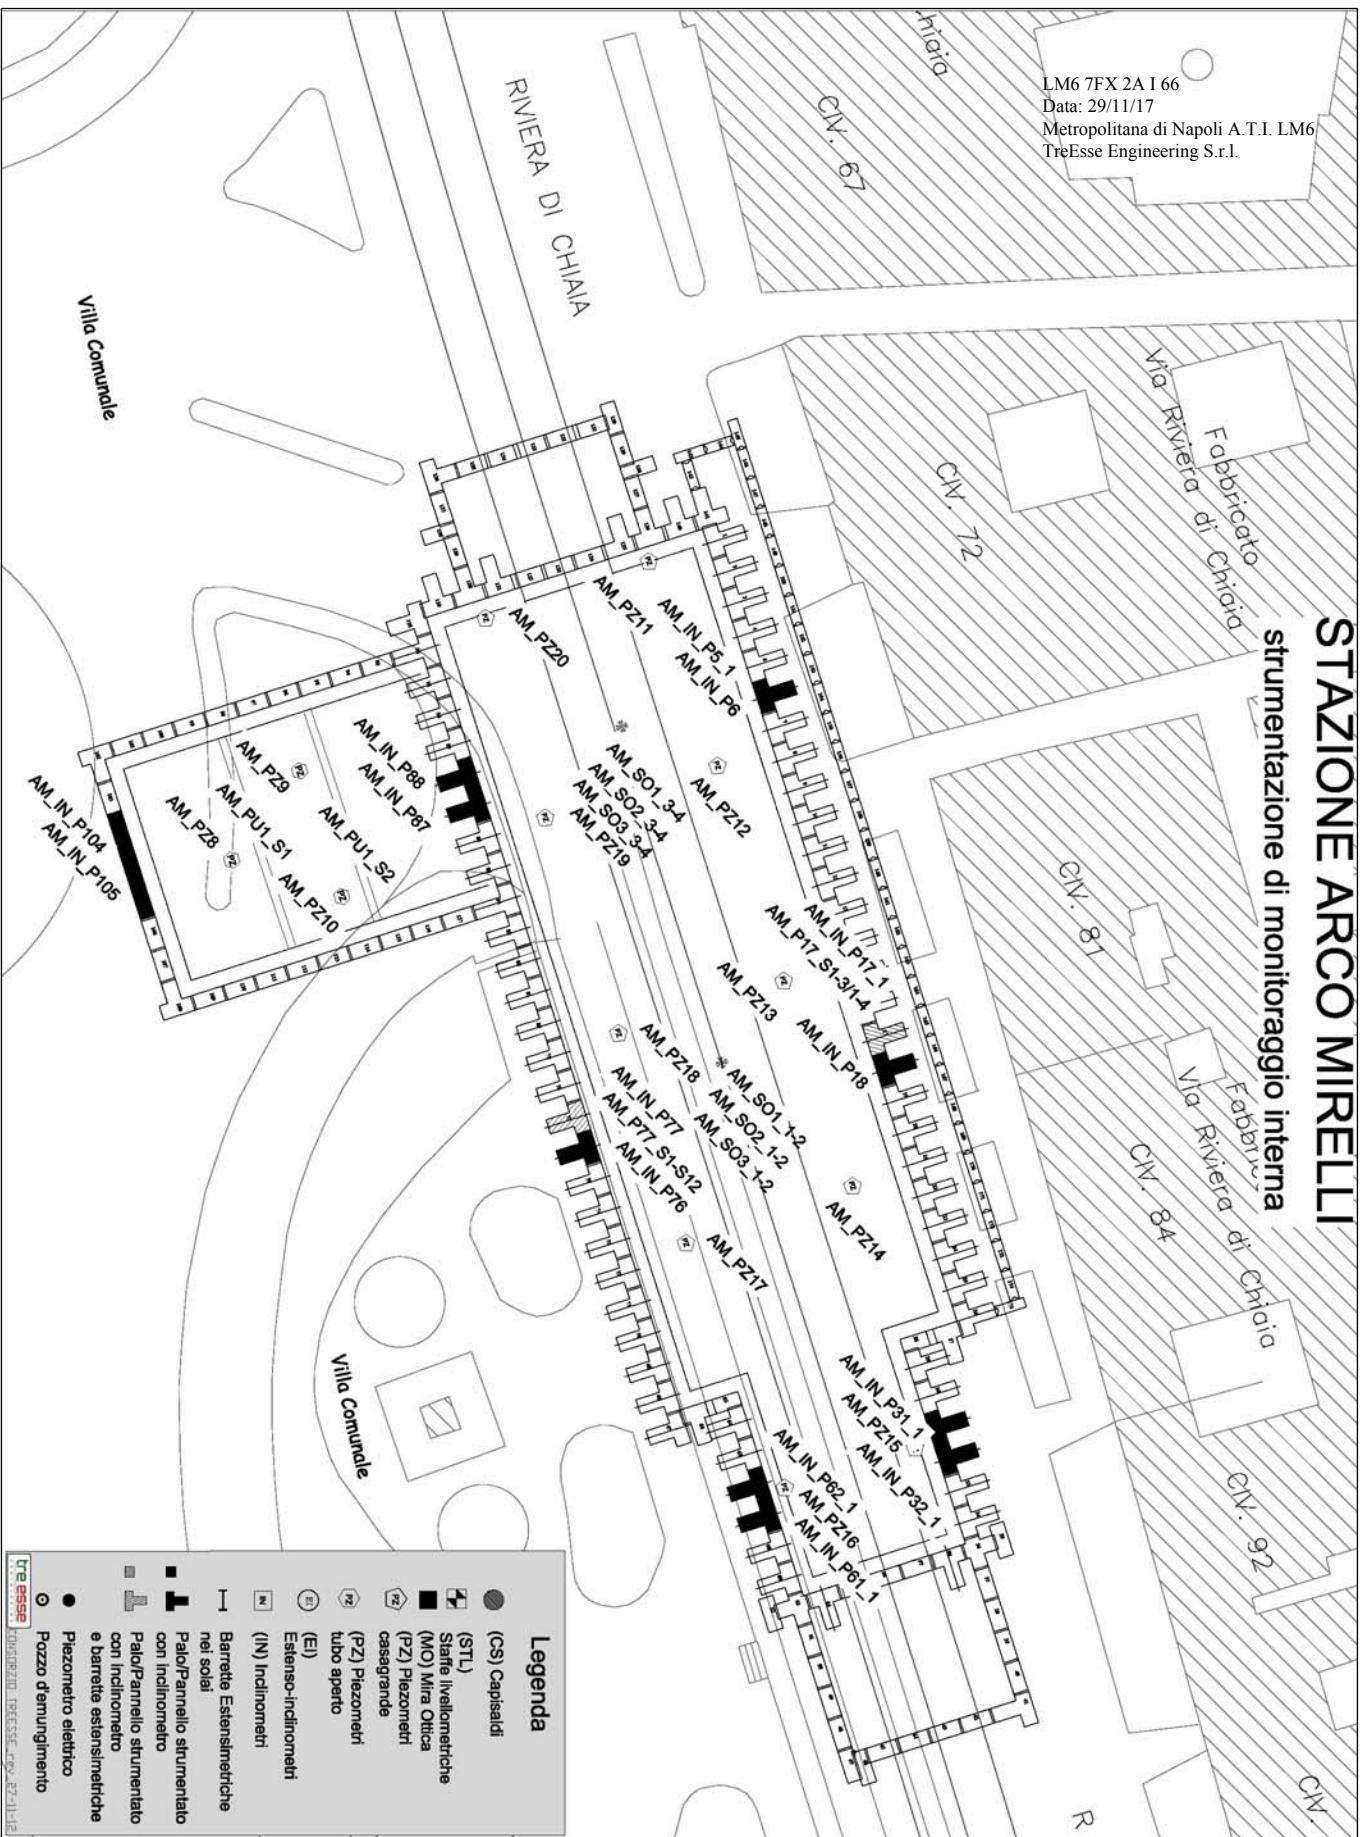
Planimetria pozzo stazione, raffigurante la disposizione della strumentazione di monitoraggio geotecnico interna.
